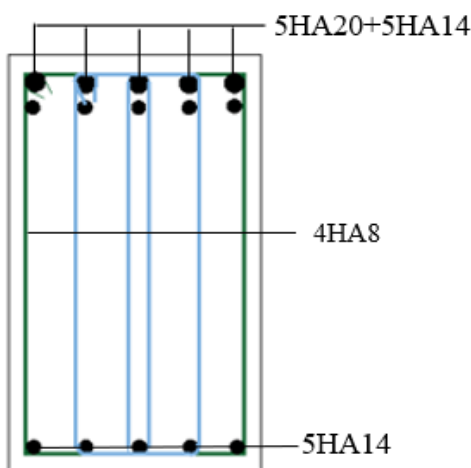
Coupe de ferrailage des poutres Secondaires au niveau de travée
